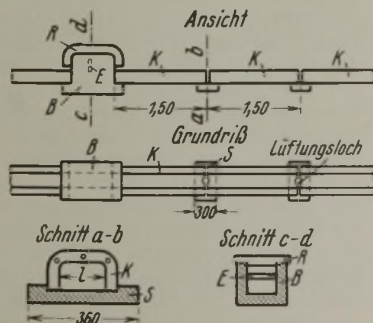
Eisenbetonkanal aus einheitlichem Profil.
